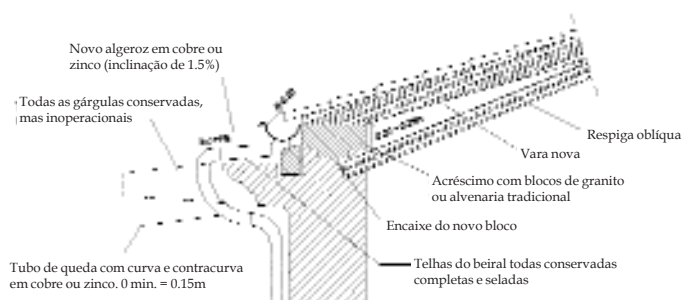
Algarozes externos das fachadas Oeste e Sul, e das fachadas do pátio interior - solução proposta
